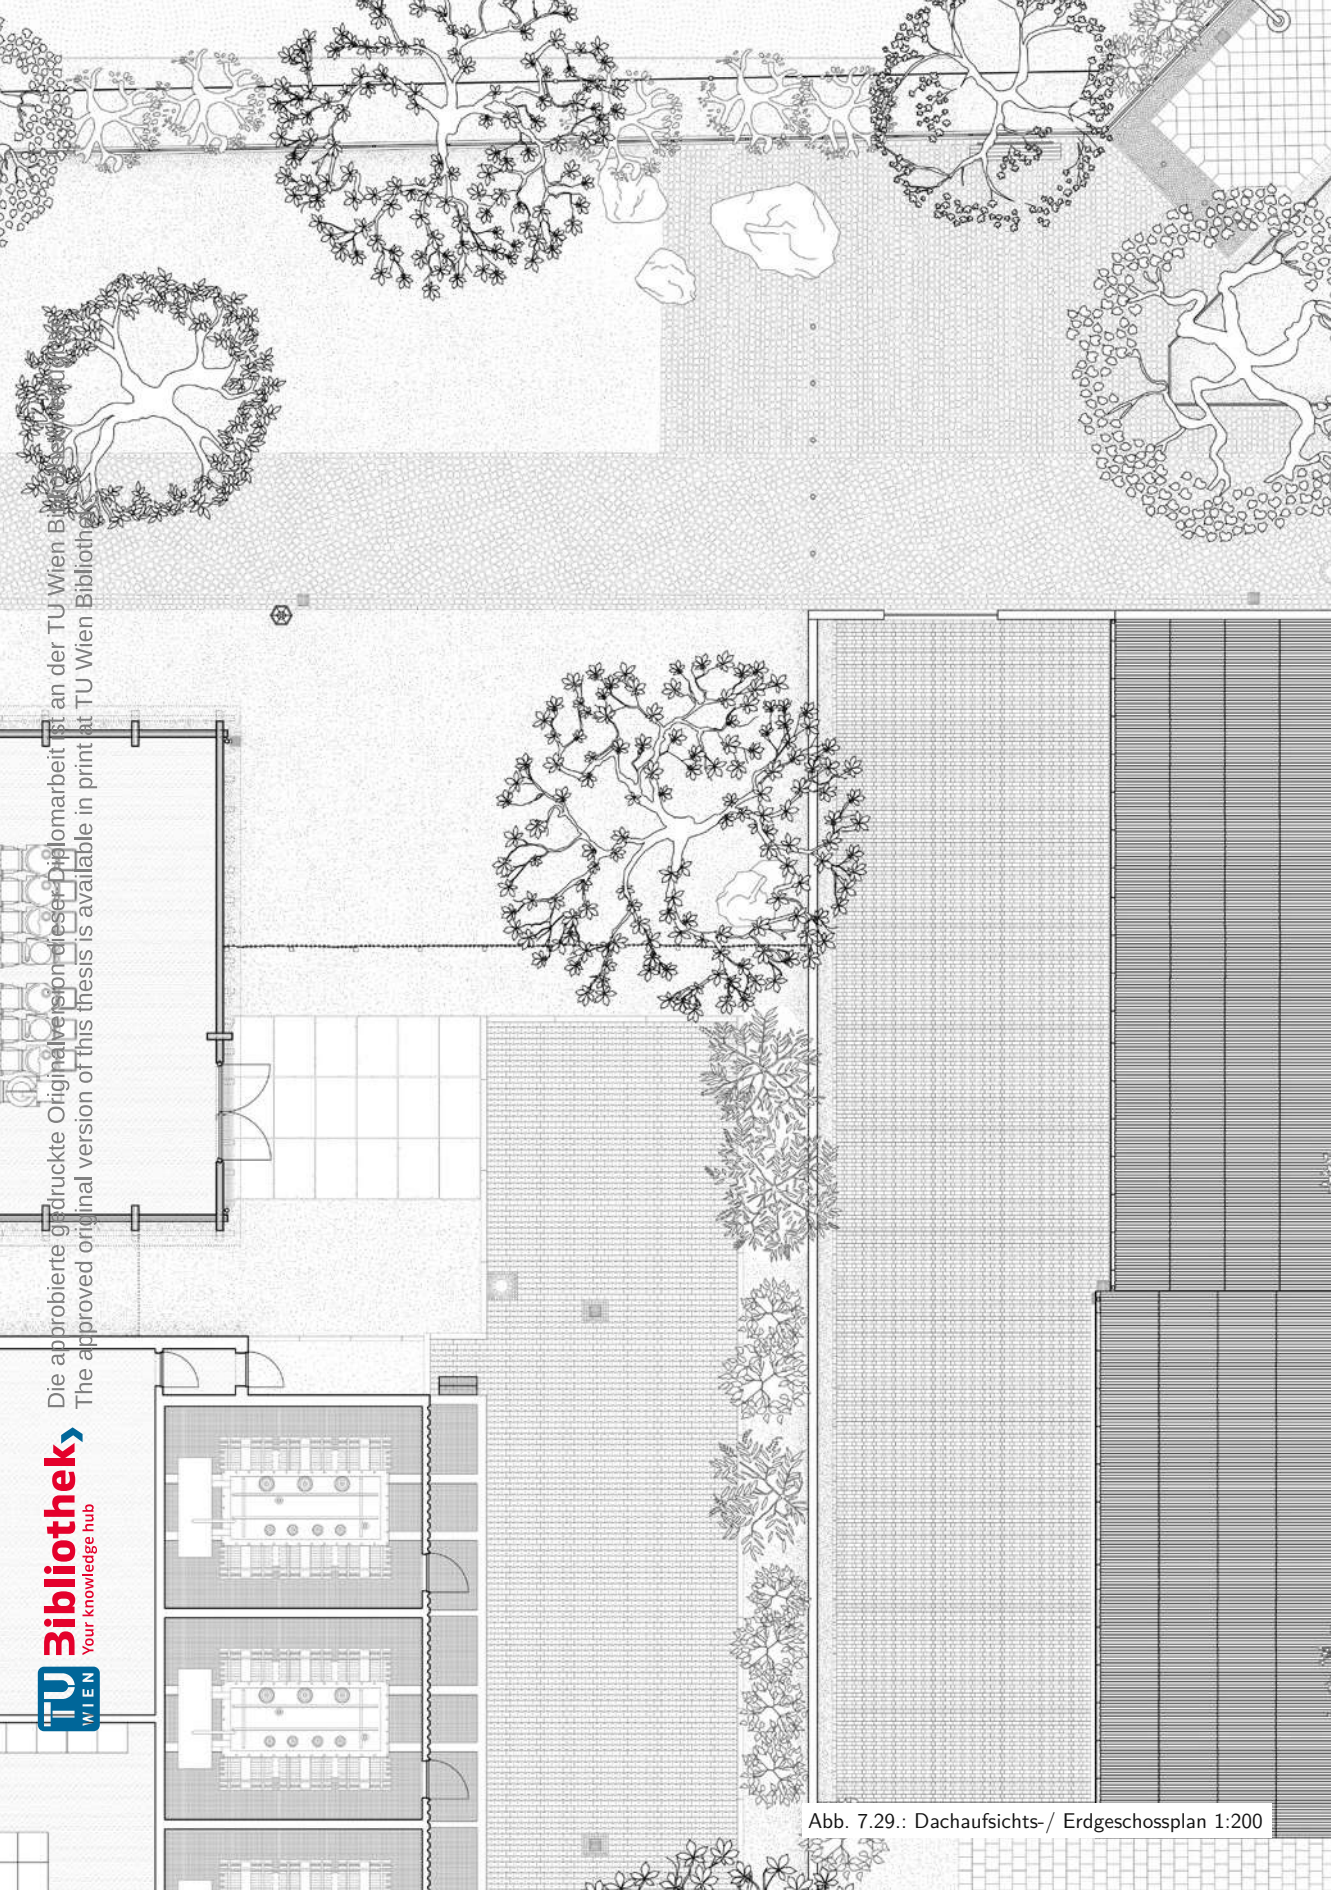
Dachaufsichts- / Erdgeschossplan 1:200
